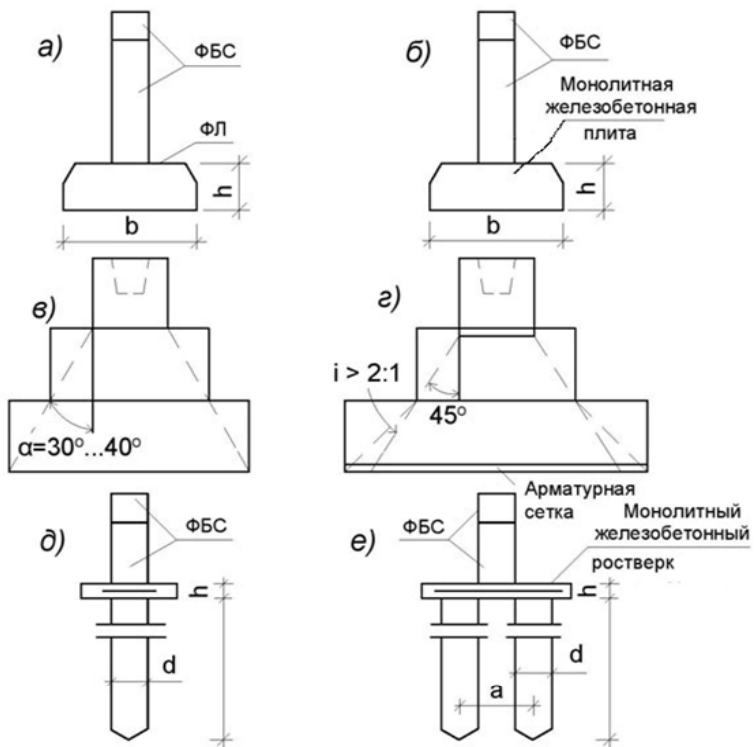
Варианты конструкций ленточных, столбчатых свайных фундаментов
